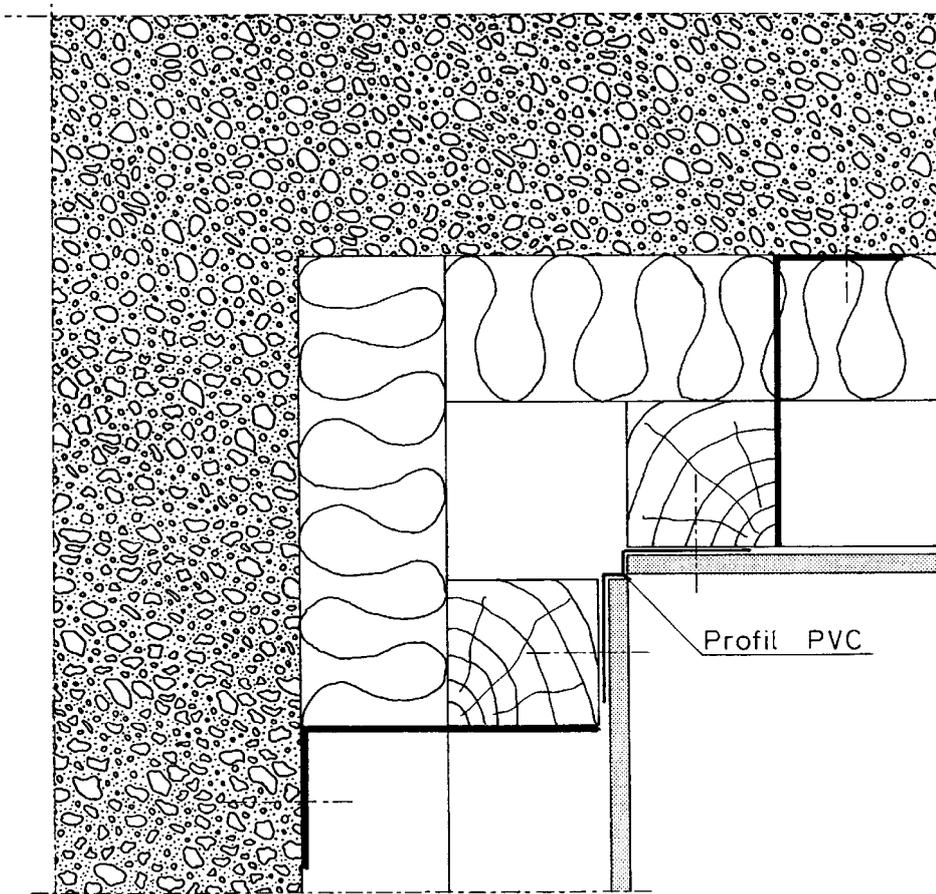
Angle rentrant coupe horizontale - Pose en bardage
